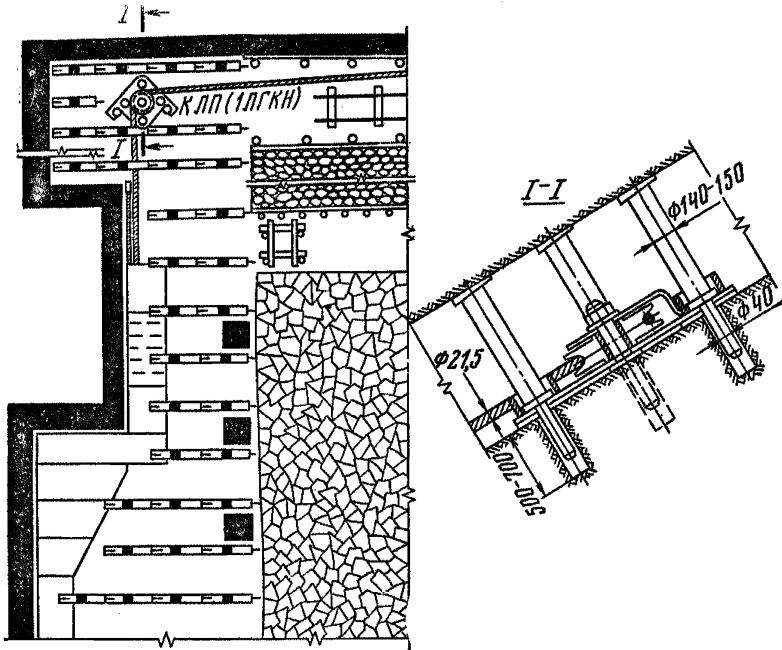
Схема крепления обводного блока предохранительного каната в лавах с широкозахватными комбайнами «Донбасс-11» и «Кировец»
